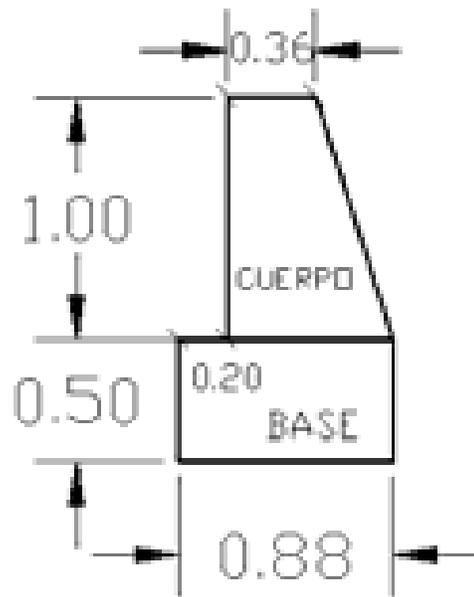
Muro de contención de la alcantarilla del kilometro 11+302.
